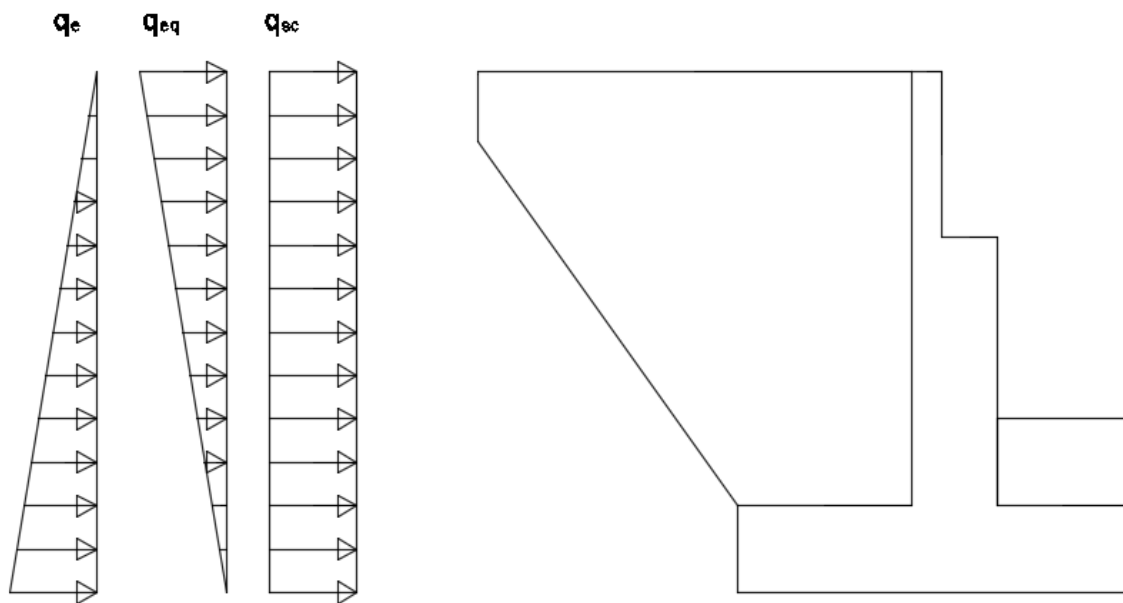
Detalle de las fuerzas horizontales actuantes sobre el estribo (Fuente: elaboración propia)
